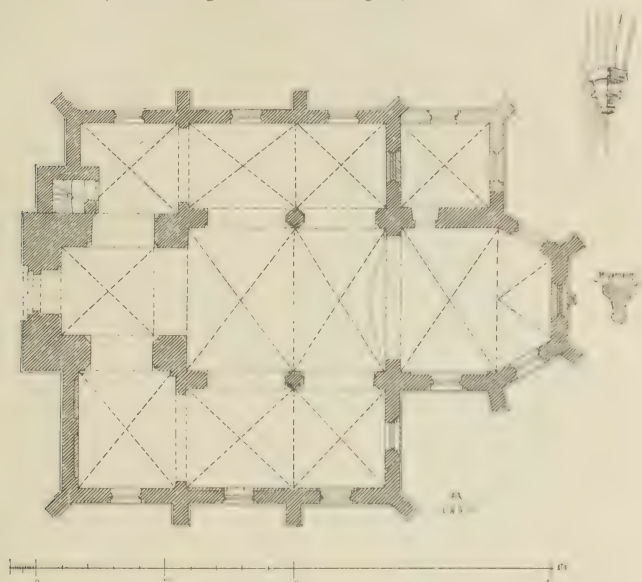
Glesch. Grundriss der katholischen Pfarrkirche
